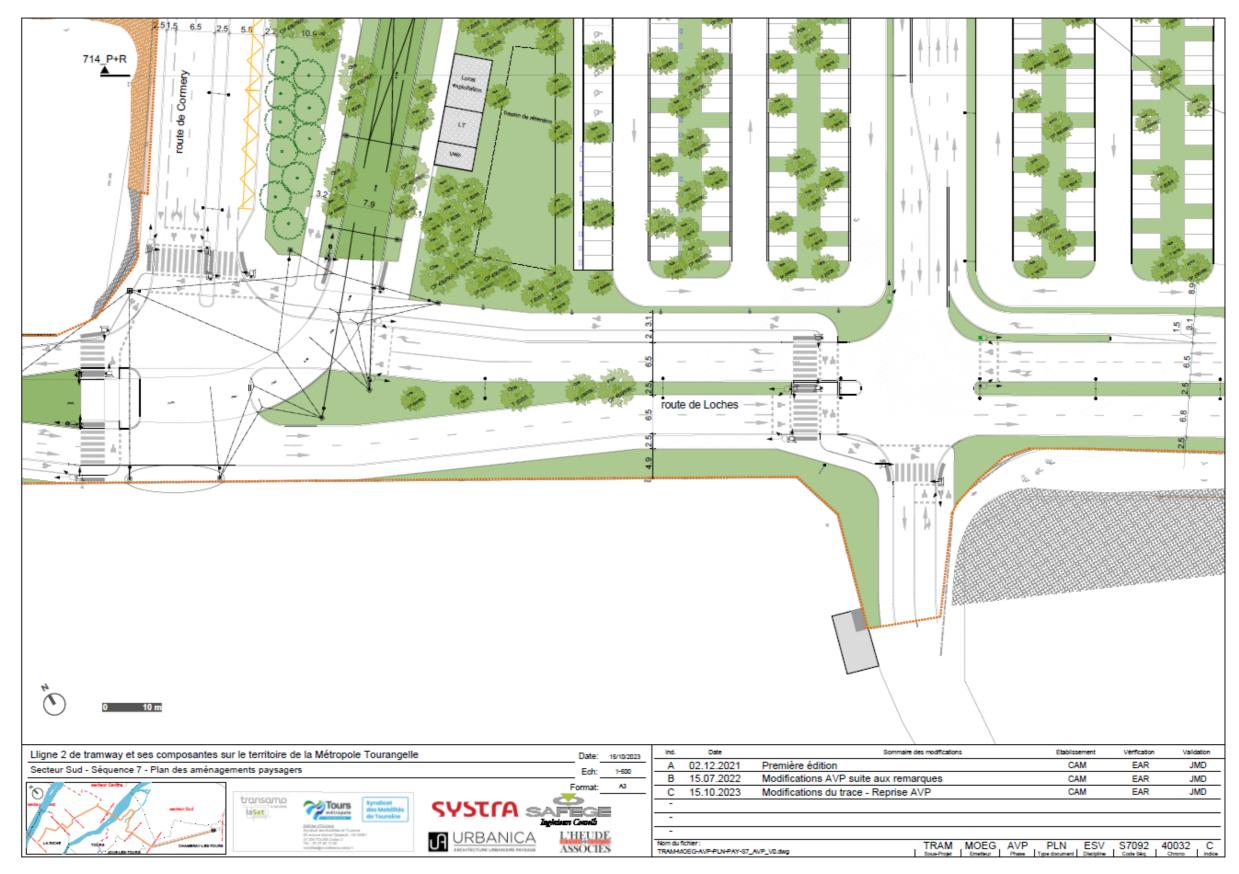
plan masse de localisation des arbres à abattre – P+R La Papoterie (planche 20)
